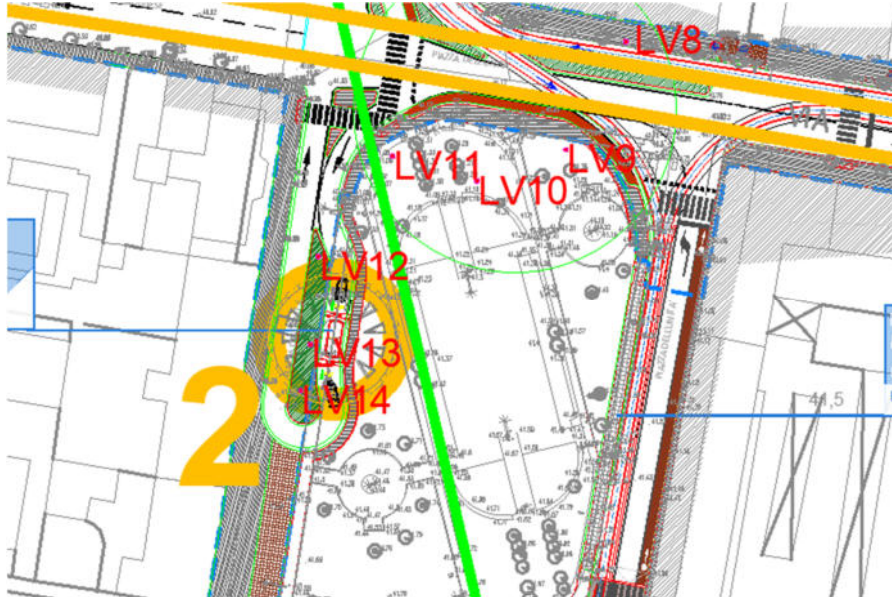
stralcio planimetrico con il dettaglio del posizionamento dei sondaggi LV12-14
